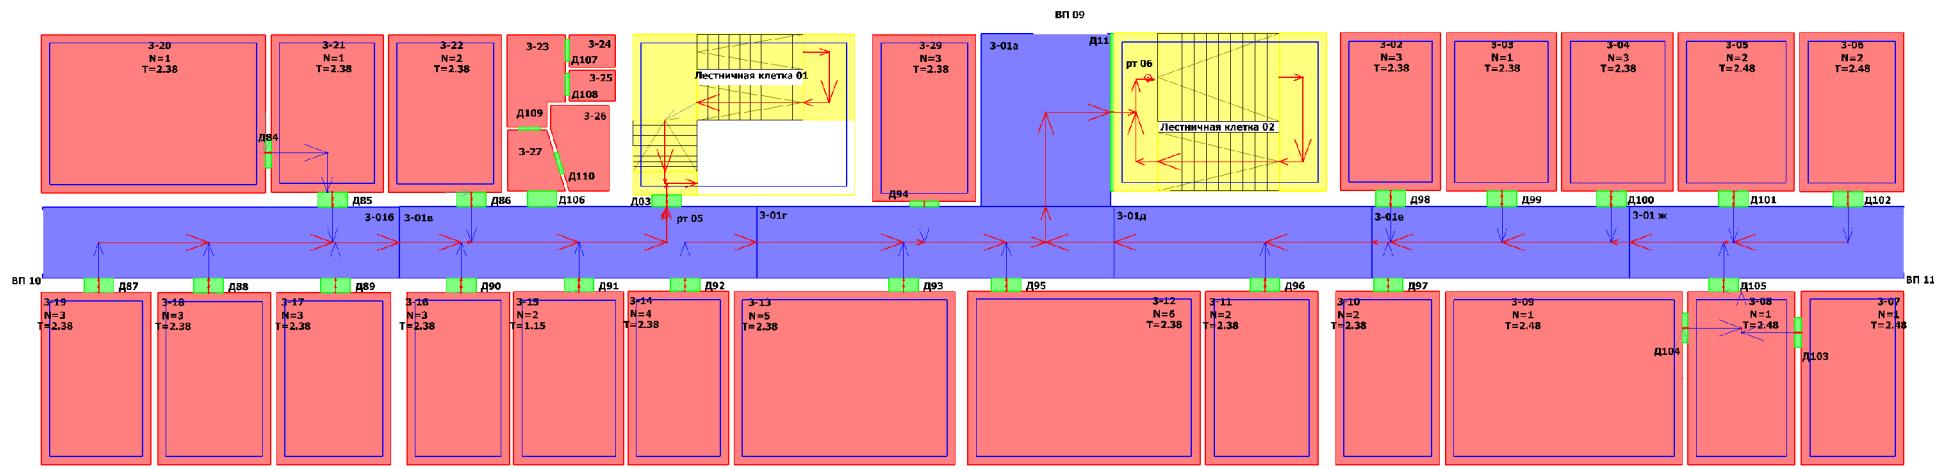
Расчетная схема эвакуации из помещений 3-го этажа здания Администрации
